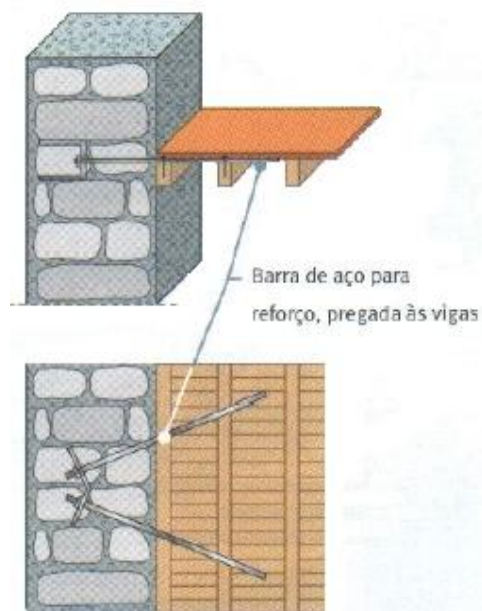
Reforço da ligação entre paredes transversais e pavimentos com barras de aço pregadas às vigas de madeira [Appleton, 2003]
